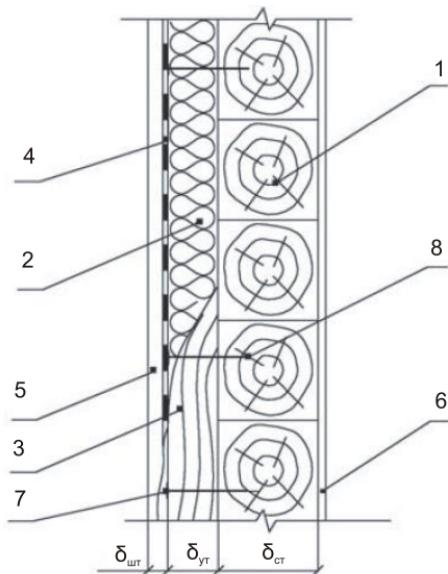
Утепление стены из бруса плитами ИЗОРОК в конструкции со штукатурным покрытием по несущей металлической сетке:
